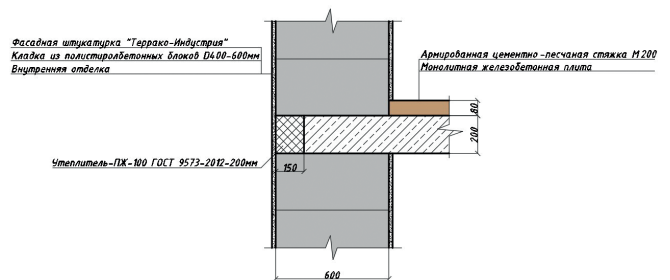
Проектное решение узла примыкания наружной стены из ПСБ-блоков к междуэтажному перекрытию. Составлено авторами согласно проекту
